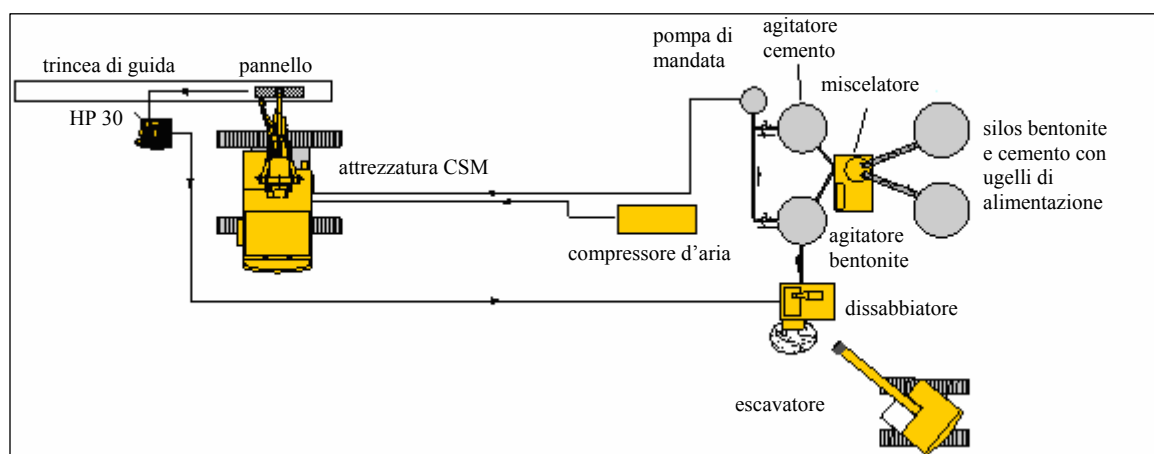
Schema in pianta del cantiere per la procedura con sistema bi-fase: esecuzione dello scavo.
